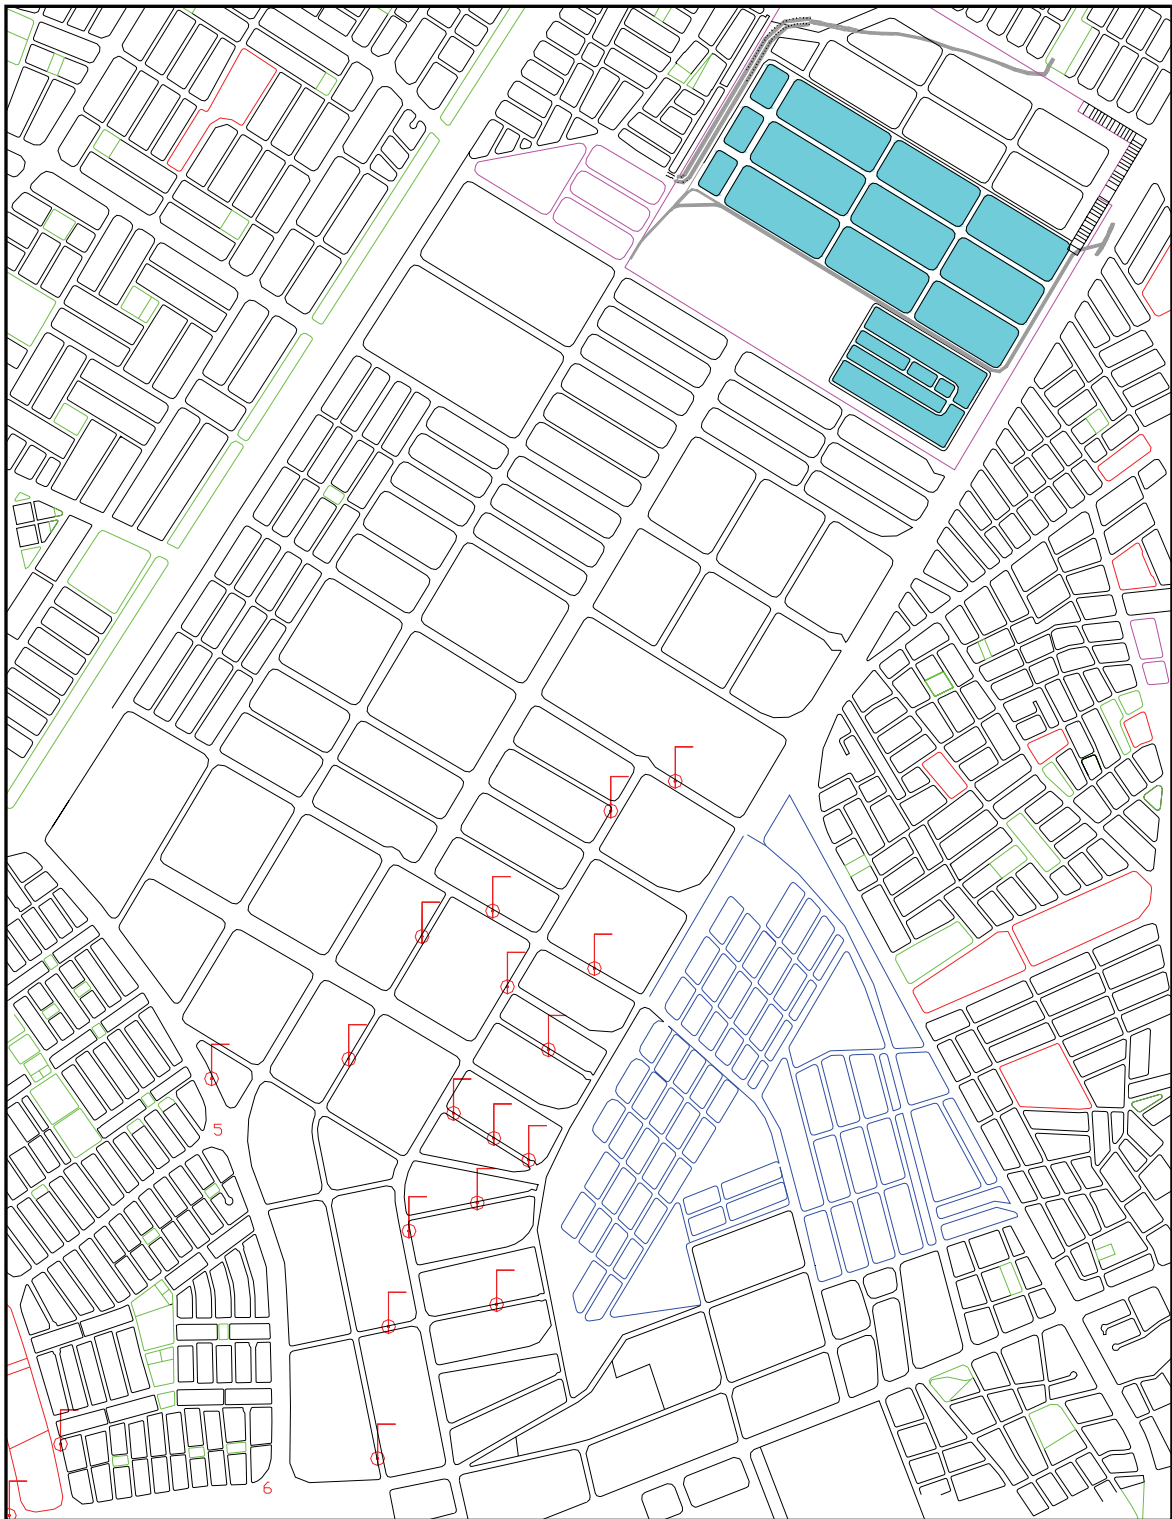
Plano en planta del parque industrial con la localización de los hidrantes
